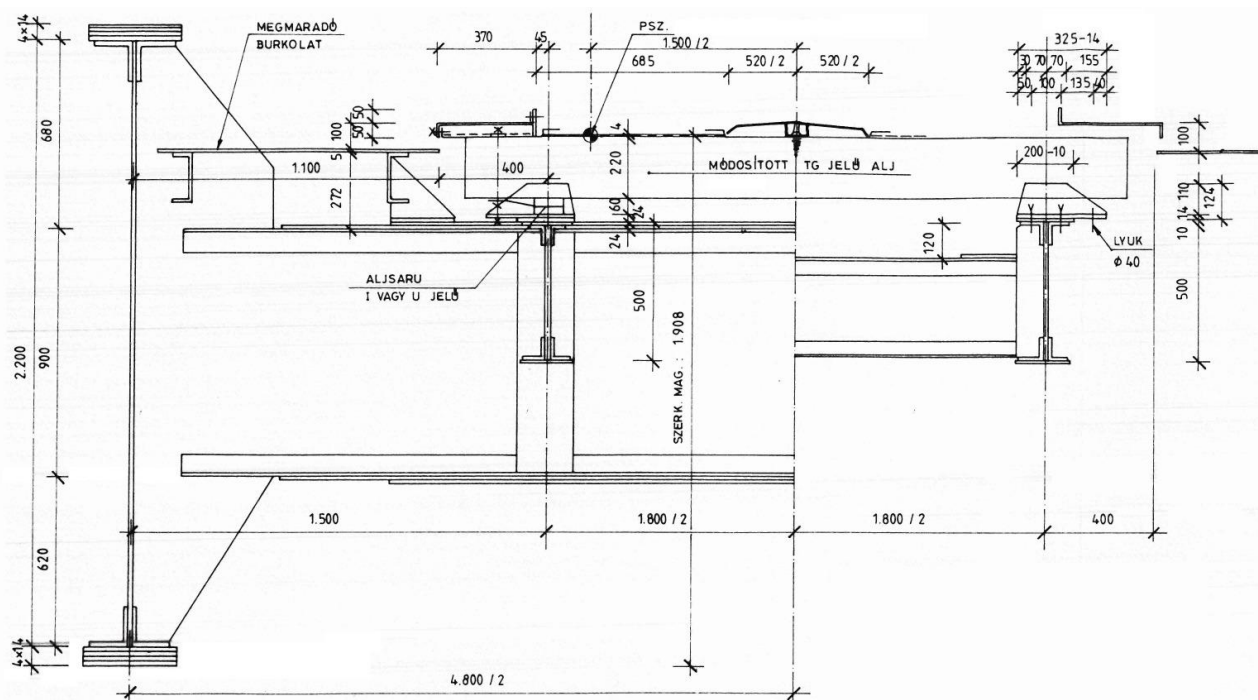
Поперечное сечение балочного пролетного строения с мостовым полотном с железобетонными шпалами.
